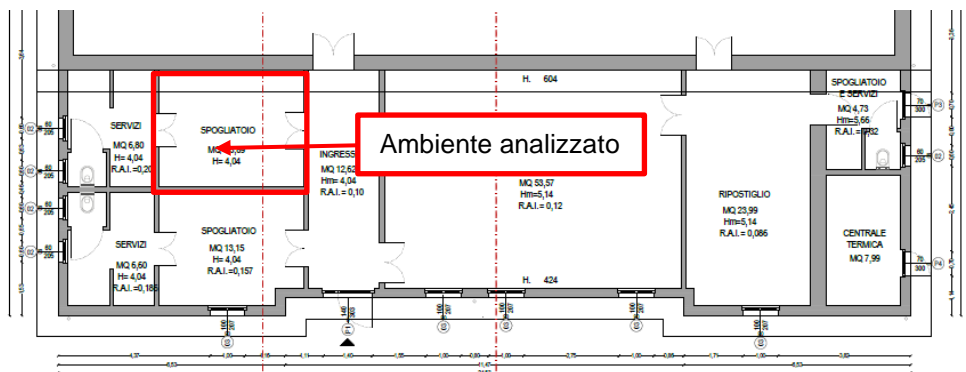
Stralcio planimetria di stato di fatto - Individuazione ambiente analizzato
